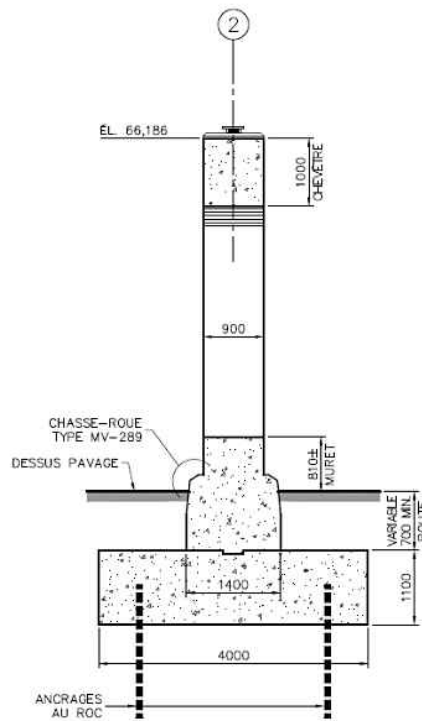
Pont d'étagement routier – Pile axe 2 – Coupe type colonnes carrées
